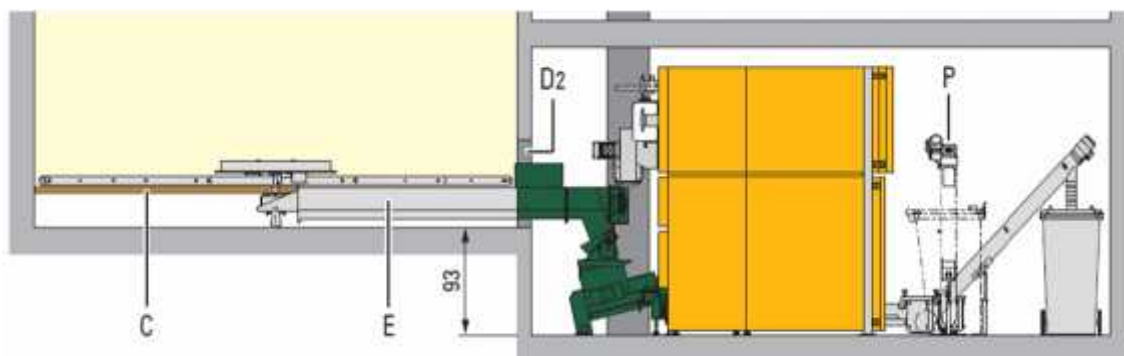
Plano alzado diseño sala de calderas propuesto por fabricante (KWB, 2018)
